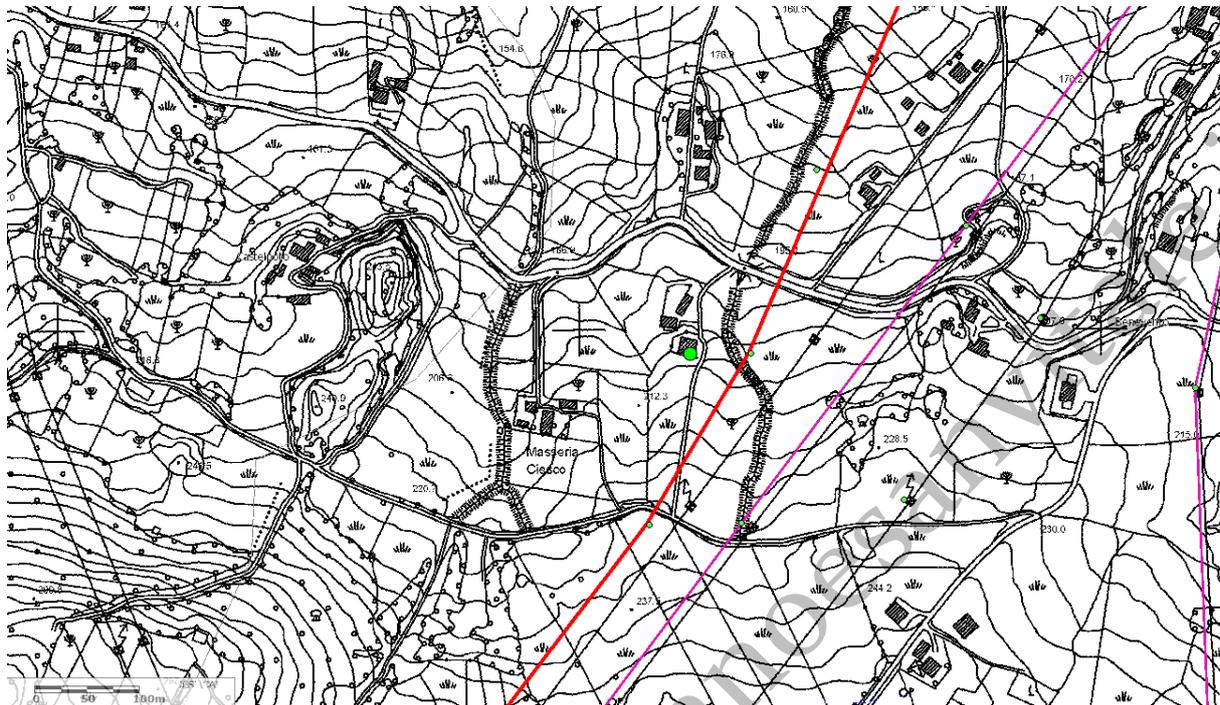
Planimetria dell'area di installazione della centralina installata in contrada Pino
